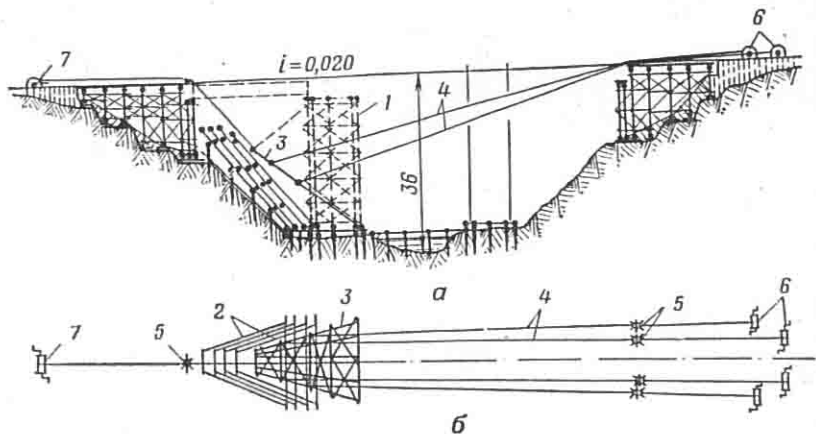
Сборка опор из плоских рам поворотом вокруг нижних насадок при помощи лебедок:
